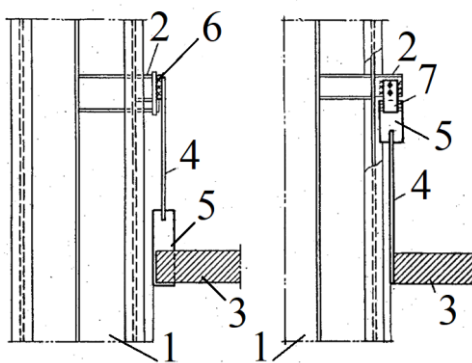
Узел соединения строительных конструкций: 1 – несущая конструкция; 2 – консоль; 3 – подвешенное перекрытие; 4, 5 – стальные полосы; 6 – опорная планка; 7 – боковые накладки
